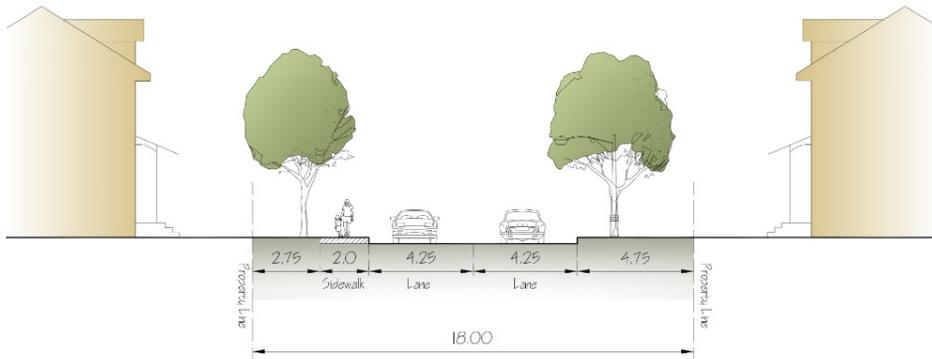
Vue en coupe d'une rue locale (18,0 m)
